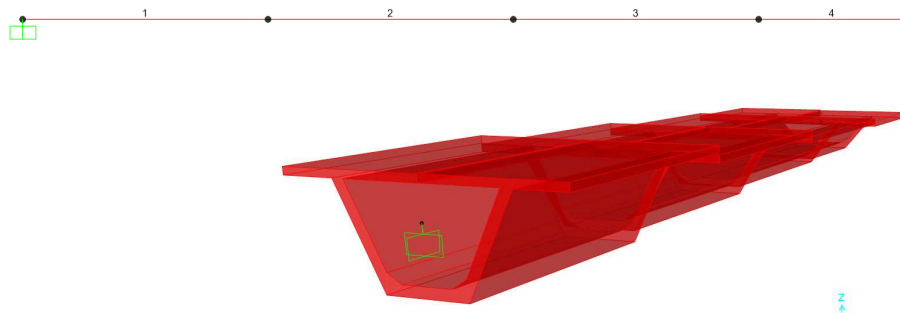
Fase 0 Schema statico (sopra) e vista estrusa assonometrica (sotto)
